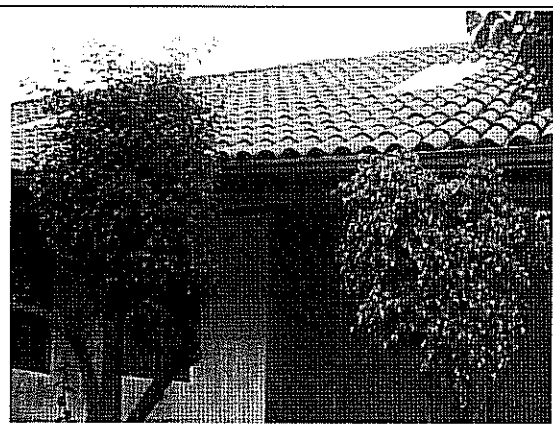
Muros y cubierta de la zona posterior en buen estado.
